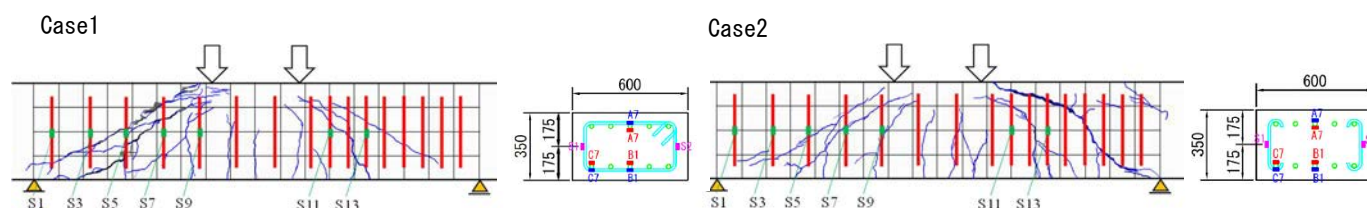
ひび割れ図 (最大せん断力時) (単位: mm)
